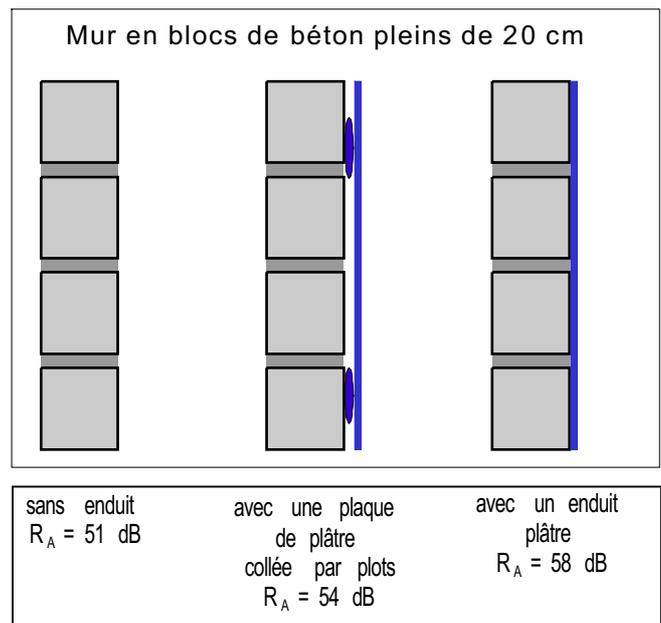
Exemple d'une paroi en blocs pleins en béton de 20 cm d'épaisseur :
